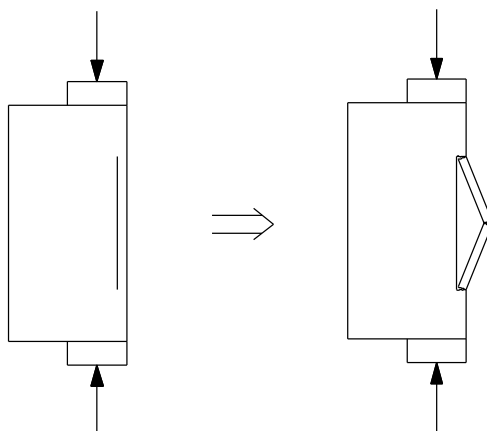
Secção de conduta aberta em granito de alta resistência com fissuras paralelas às tensões principais de compressão em que as forças transversais provocam destaque de lâminas de granito.
